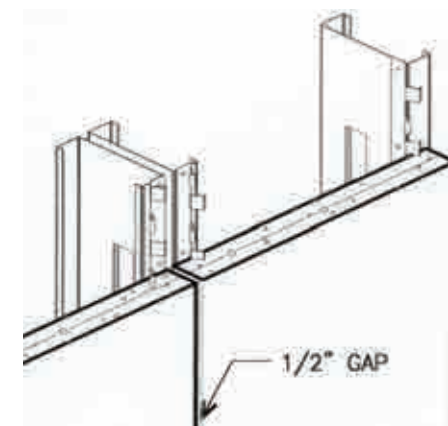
Patente 'Reinforced structural member for building constructions'.
